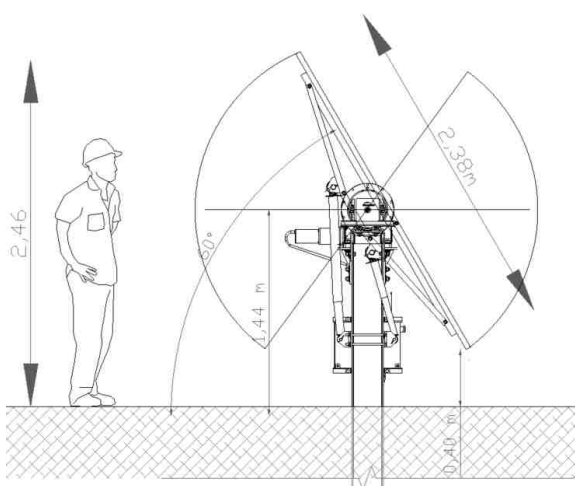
, 5: vista laterale tracker ed esempio di fissaggio delle strutture di supporto.
